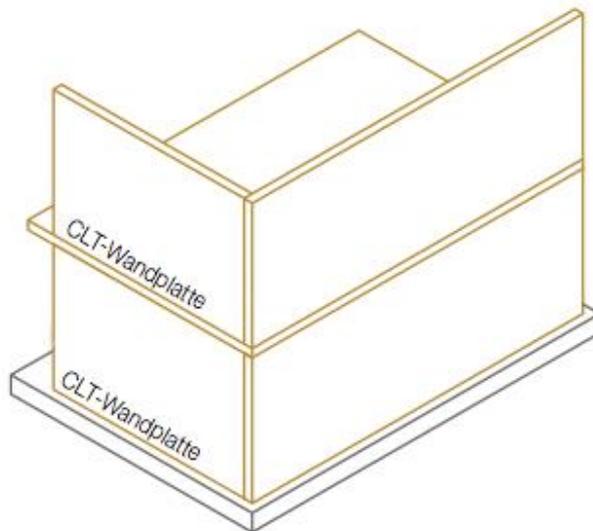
Grundlegende Konstruktionsregeln – Variante I¹⁷⁴
